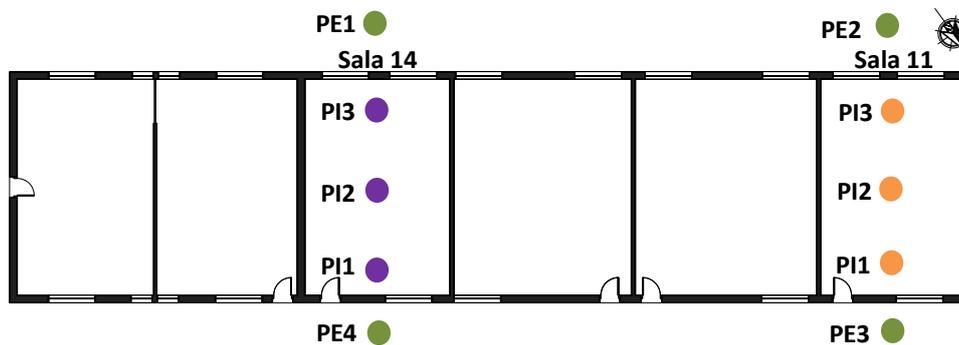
Planta Baixa do Prédio 63 com a localização dos pontos de medição nas salas 11 e 14.
